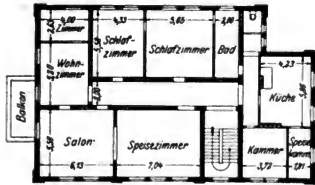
Betriebsamtsgebäude in Belgig. (Obergeschoß.)
